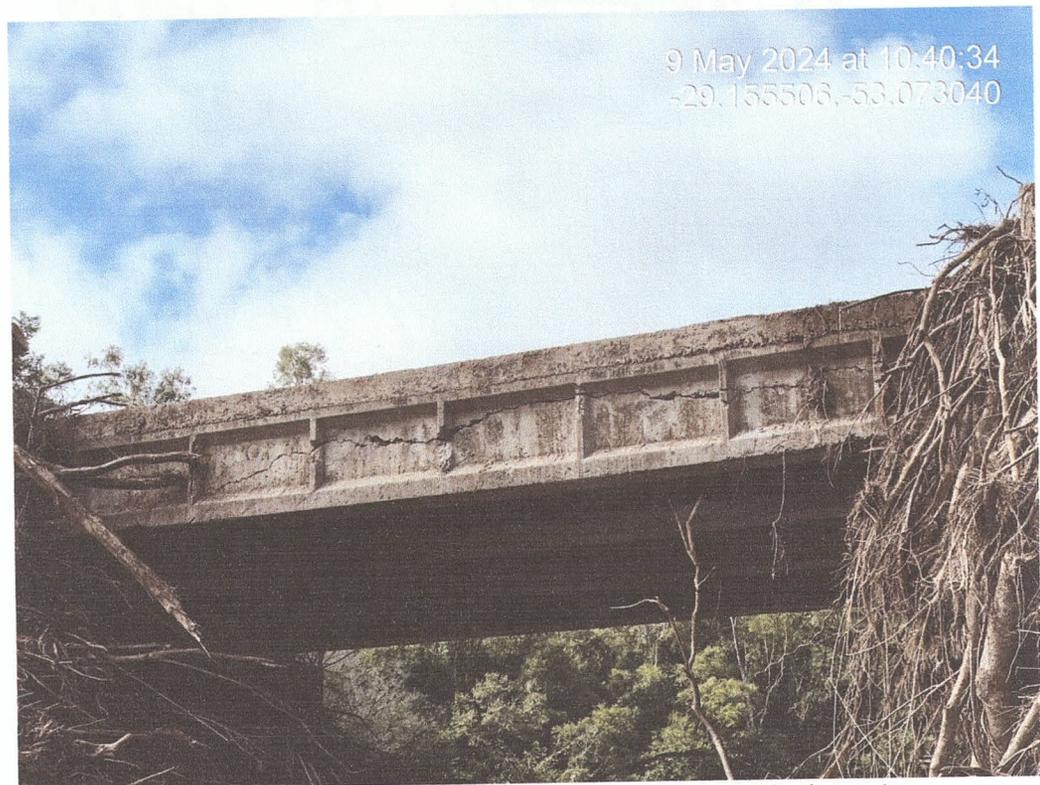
Fissura localizada na viga de suporte à laje da ponte
